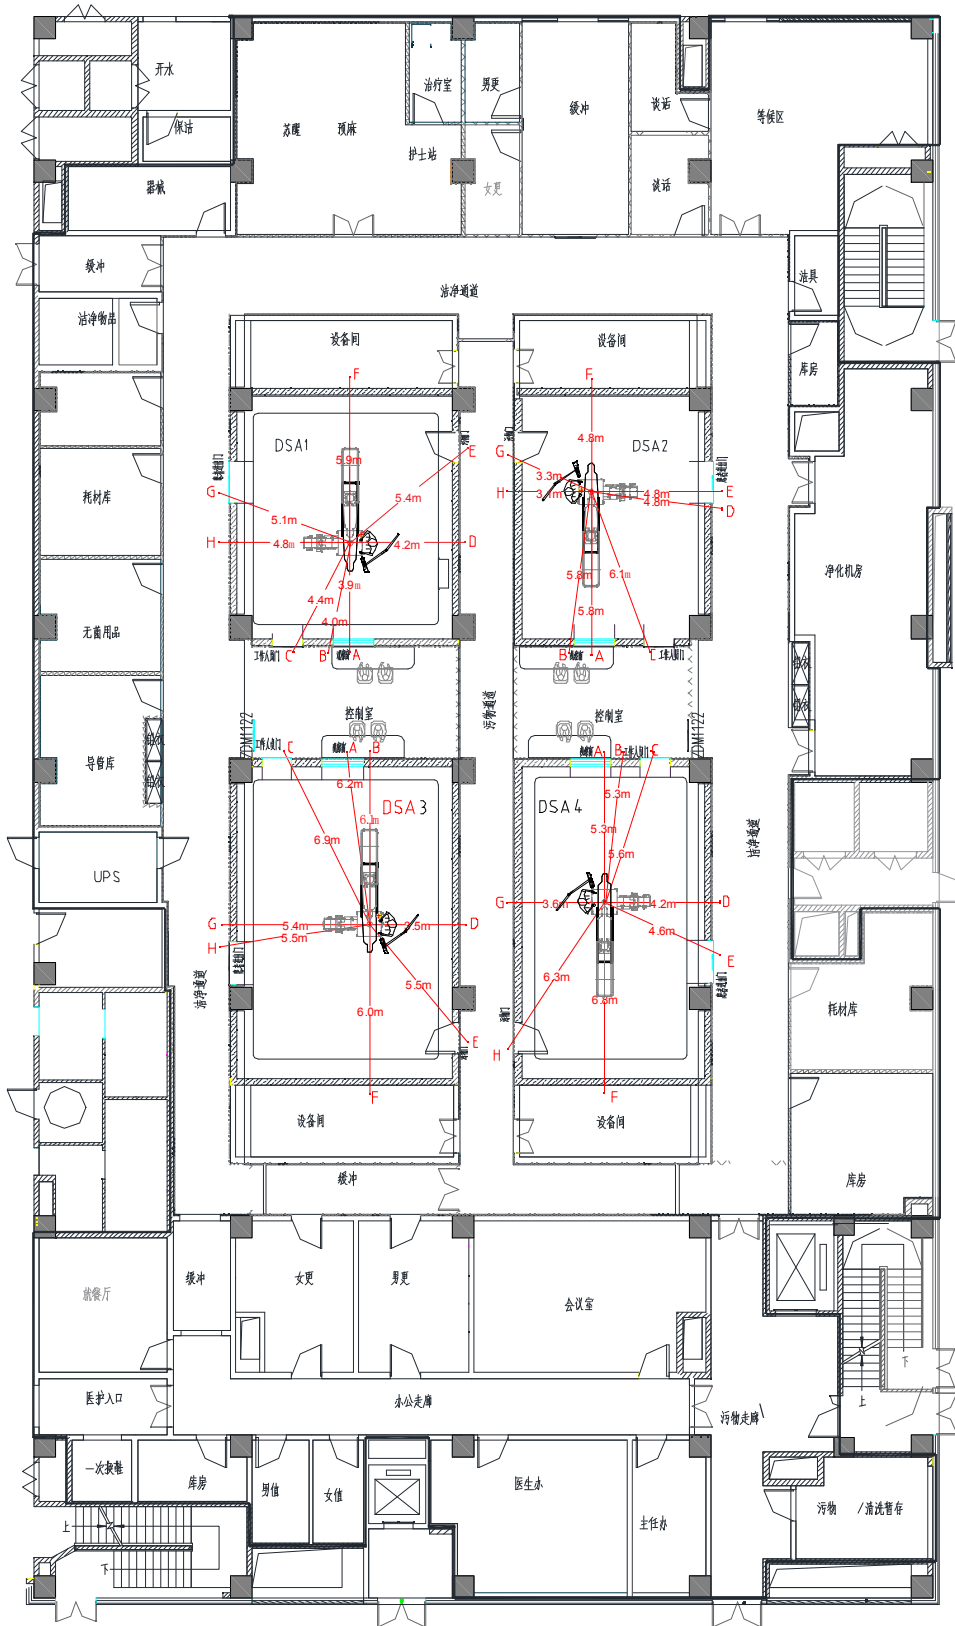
东门诊医技楼一层介入中心 DSA 机房估算点位图（平面）
